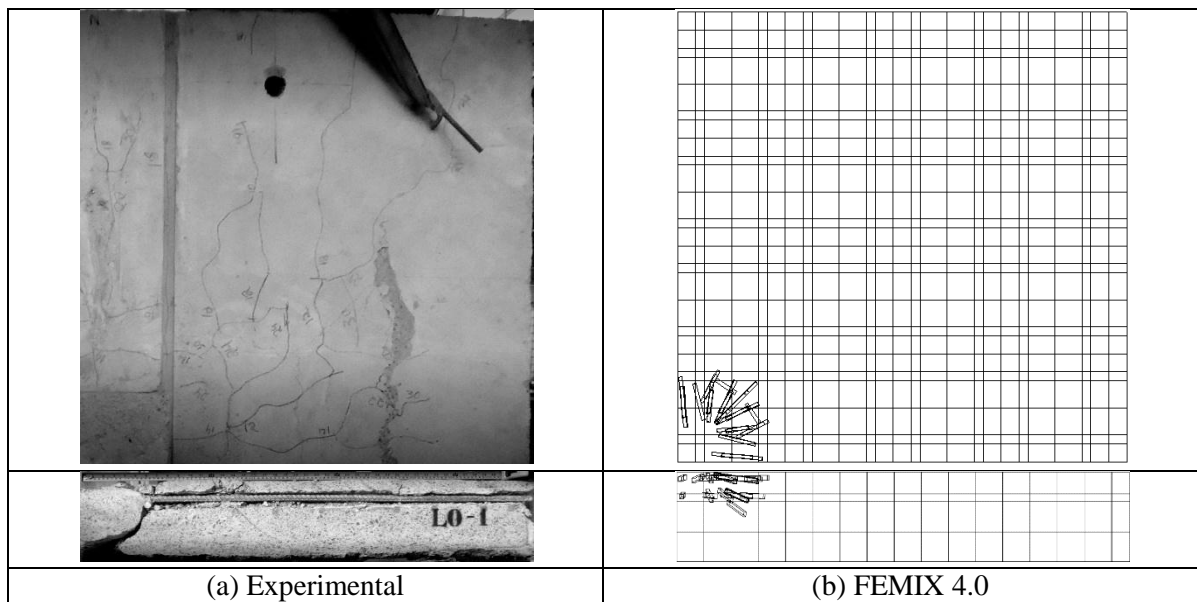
Padrão de fissuração - L0-1 (FEMIX 4.0)
